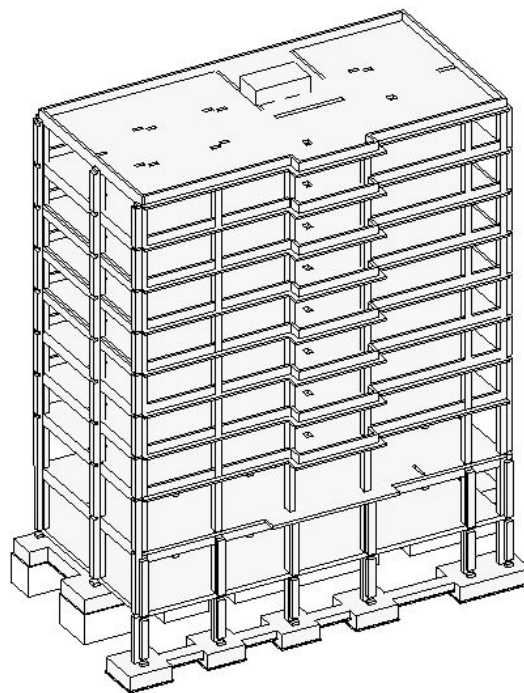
Modelo 3D Da Estrutura (Revit)
